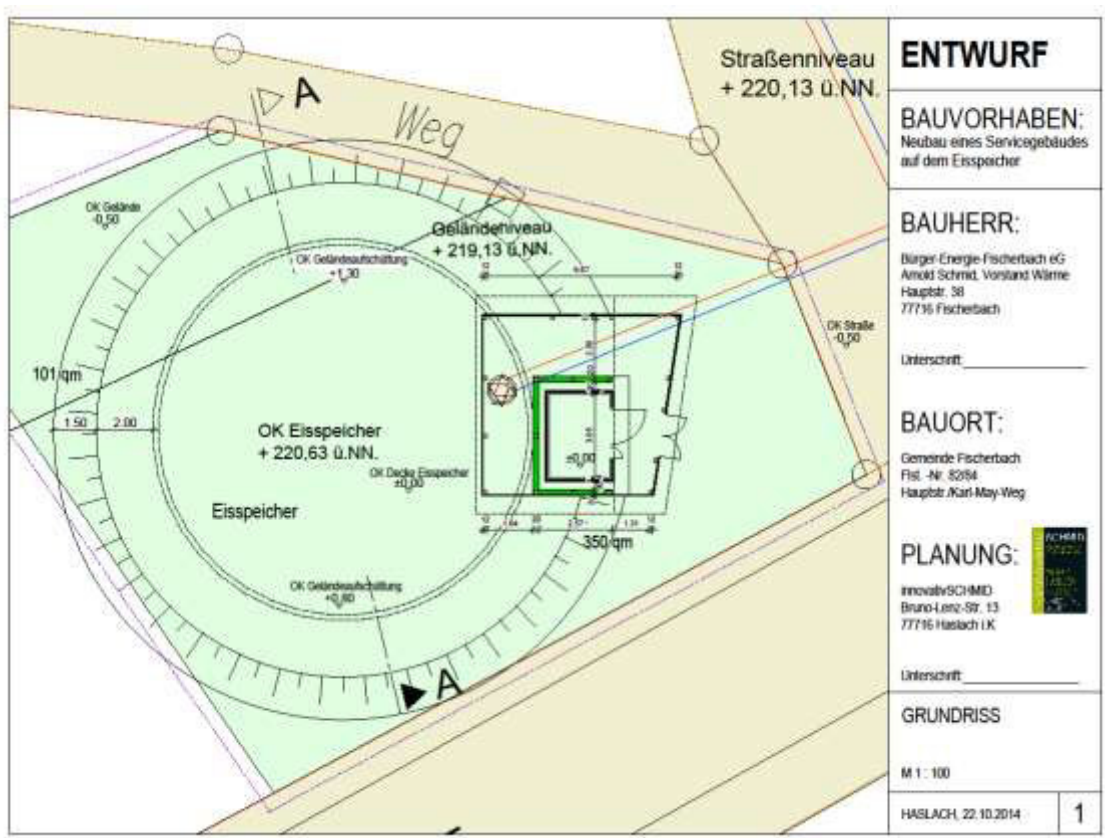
Grundriss Eisspeicher mit Technikgebäude
